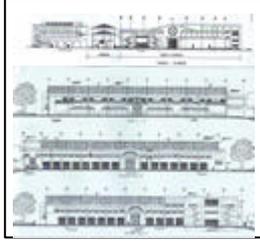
Fachadas – Proyecto de La Plaza de Mercado de la Esmeralda .
